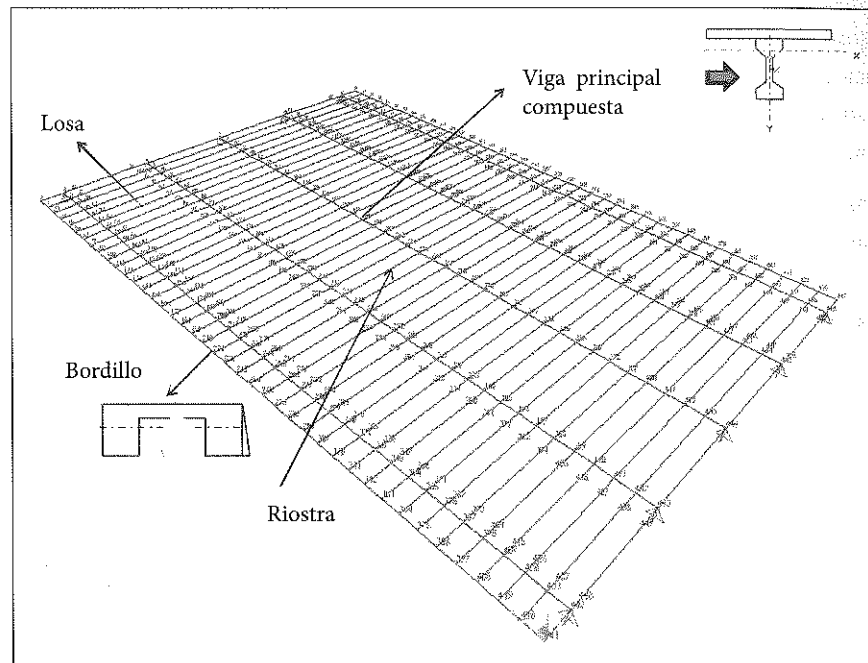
Modelo estructural del tablero del puente desarrollado en SAP2000.
